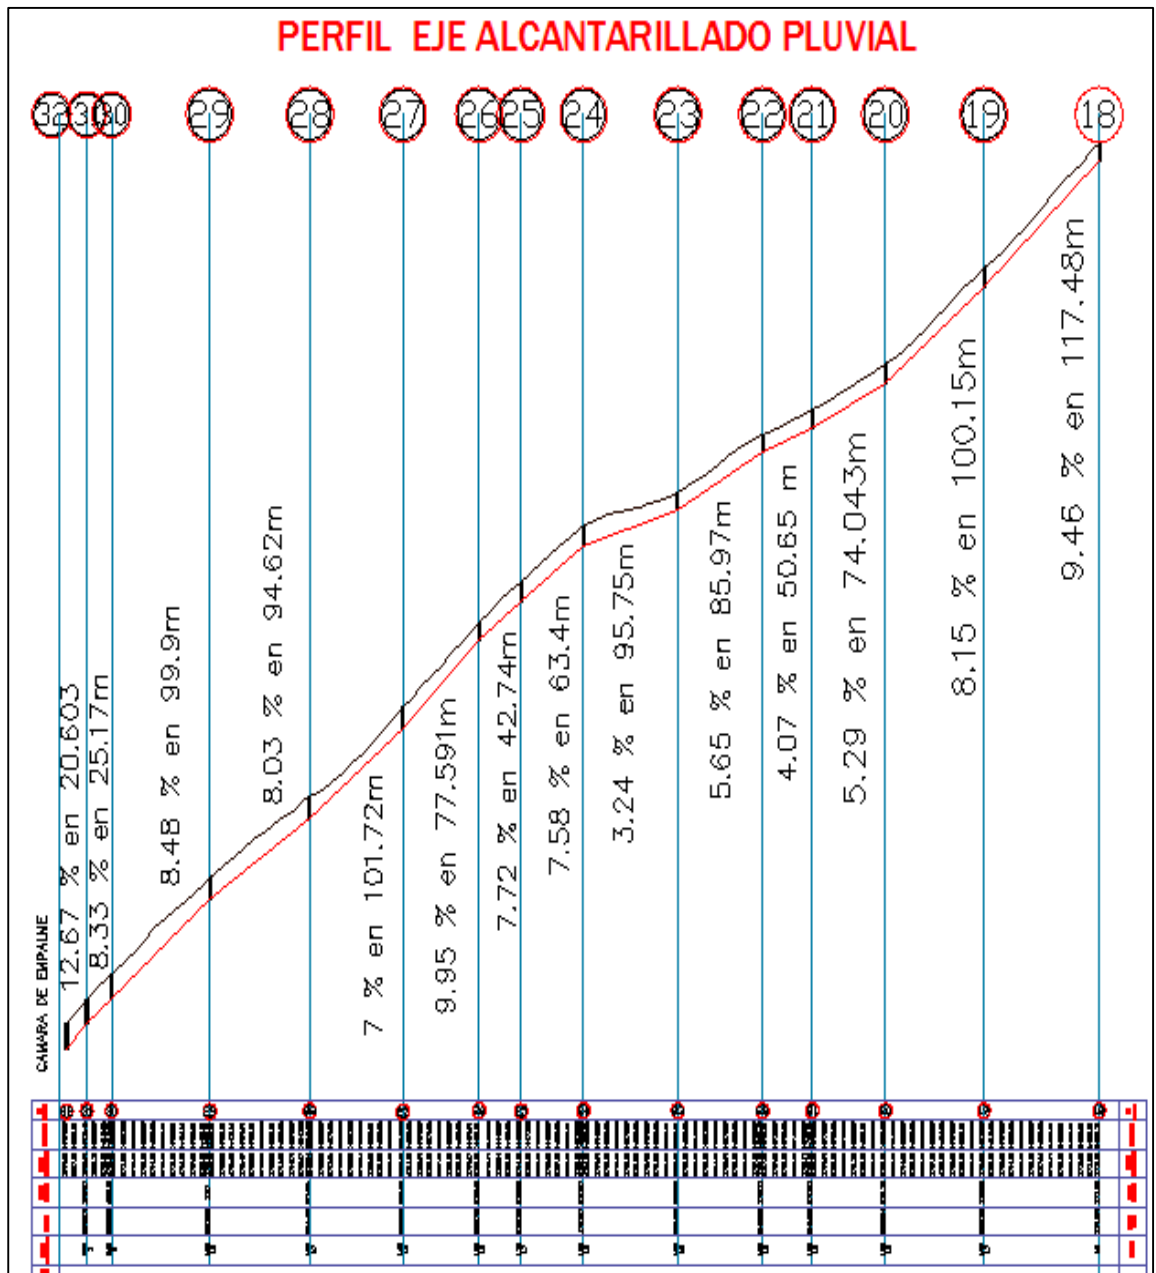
Perfil alcantarillado pluvial sector Jongovito centro
